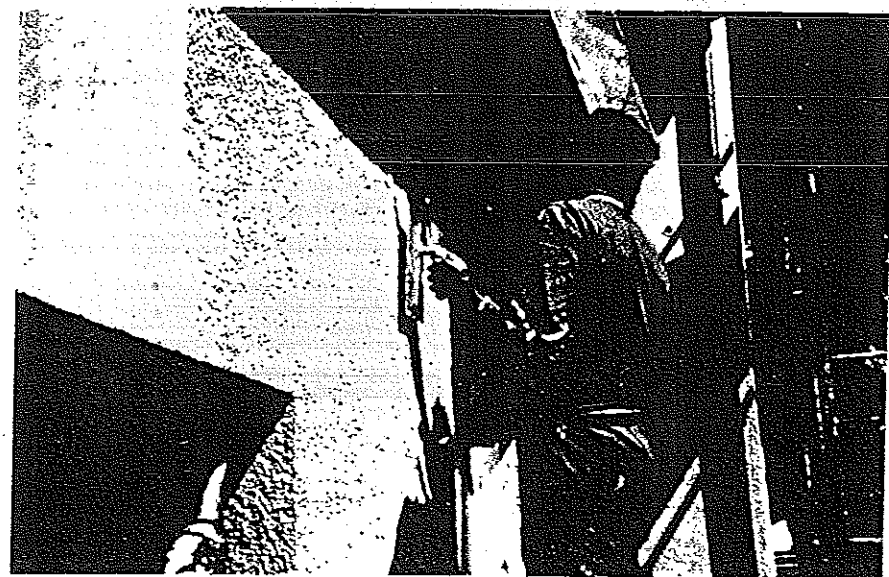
Application à la lisseuse d'un revêtement d'imperméabilisation sur un enduit extérieur.
